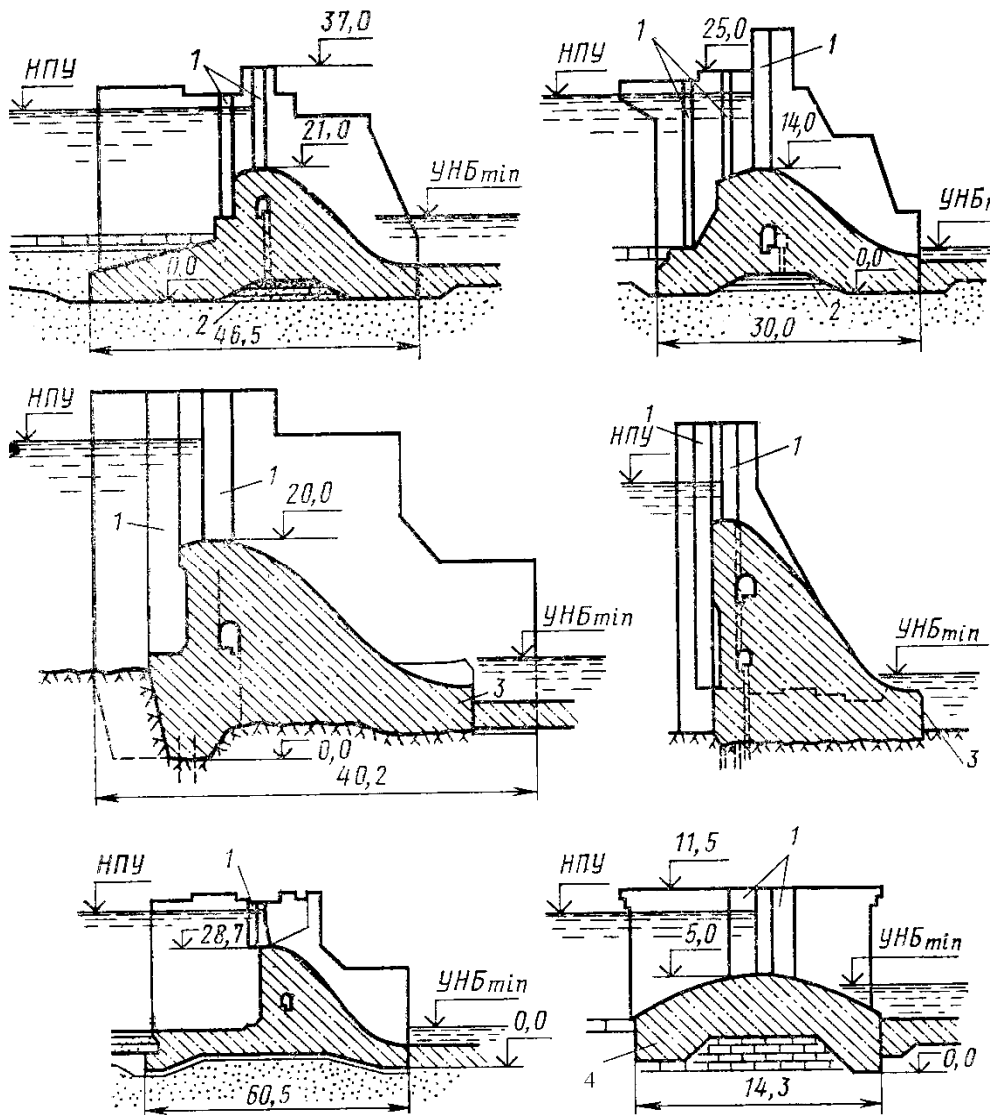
Схемы водосливных плотин на нескальном основании:
